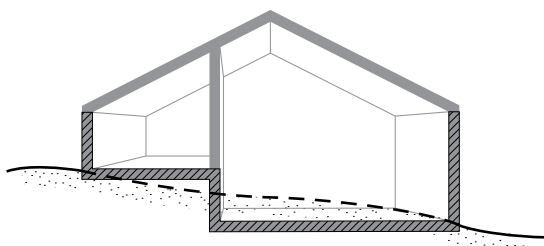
Bebyggelse opføres i forskudt plan, så den tilpasses det eksisterende terræn.
